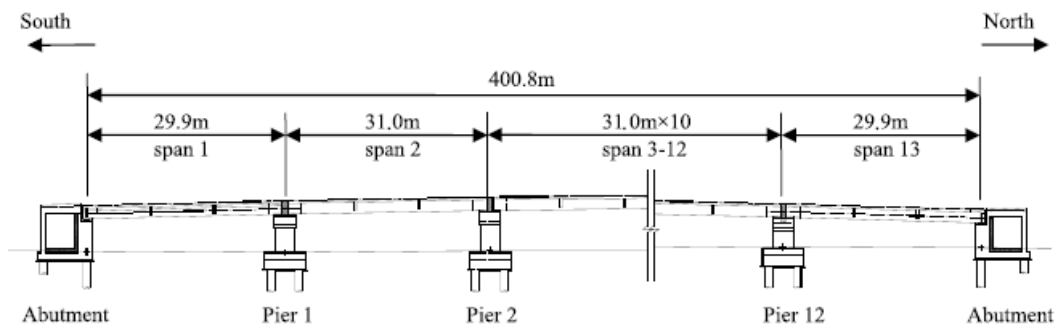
Ponte di Isola della Scala – Sezione longitudinale (Zordan, 2010)
